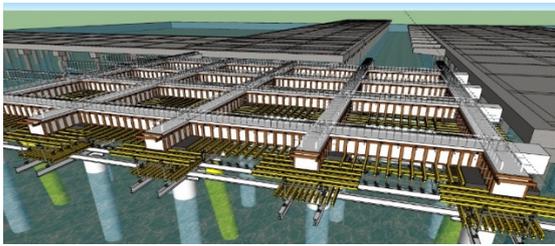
Ilustrasi Pemasangan Rangka Bekisting Pier
